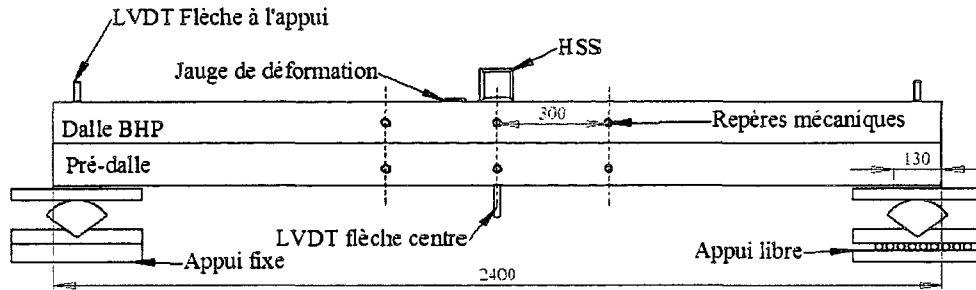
Schéma du montage de l'essai de flexion sur système pré-dalle/dalle
